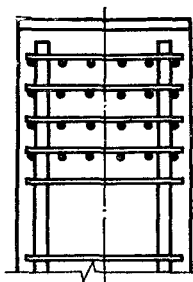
Косвенное армирование в виде пакета поперечных сварных сеток.
